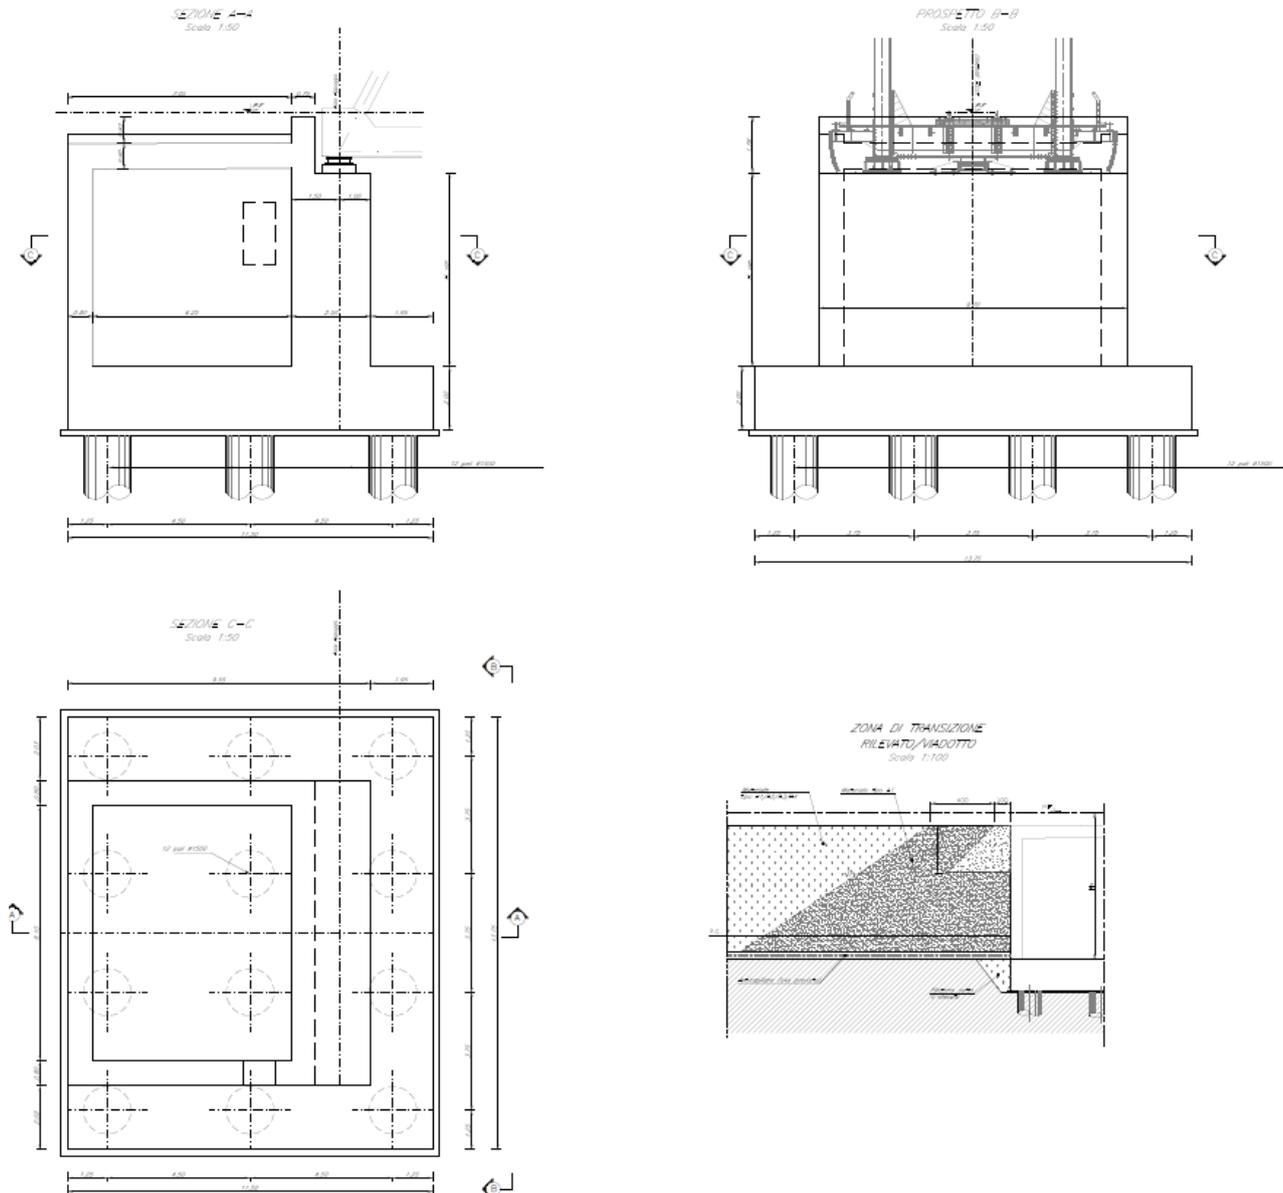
Carpenteria Spalla Campata L=69.70 m
